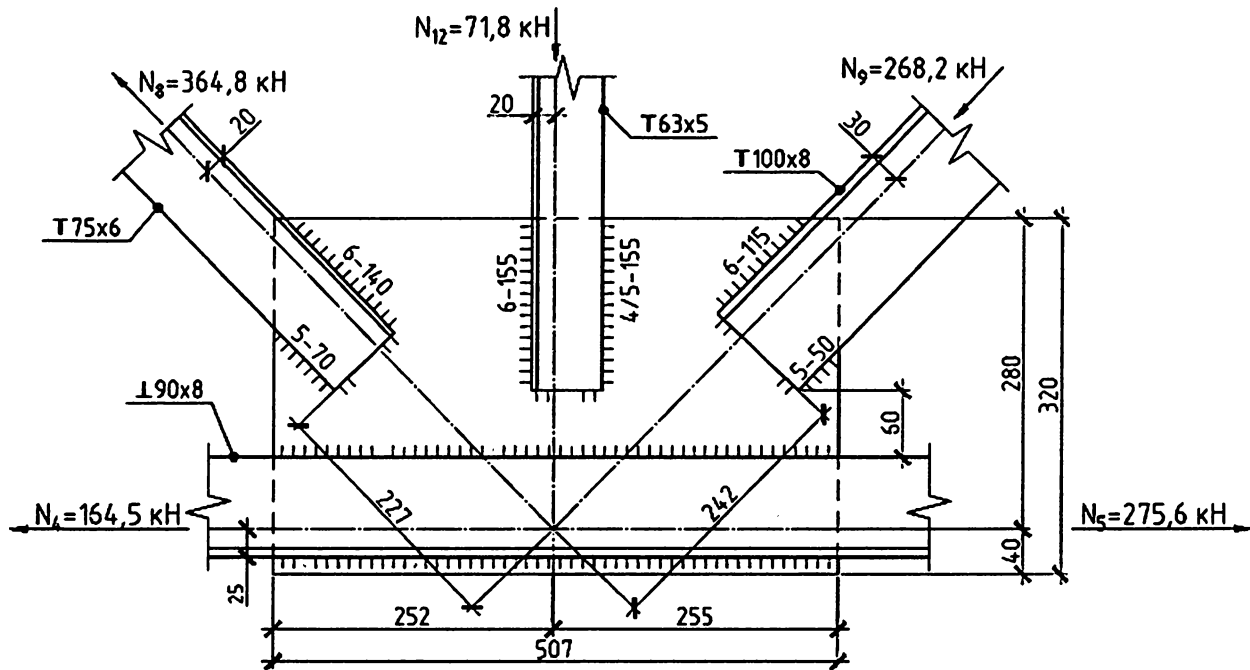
Промежуточный узел нижнего пояса фермы
